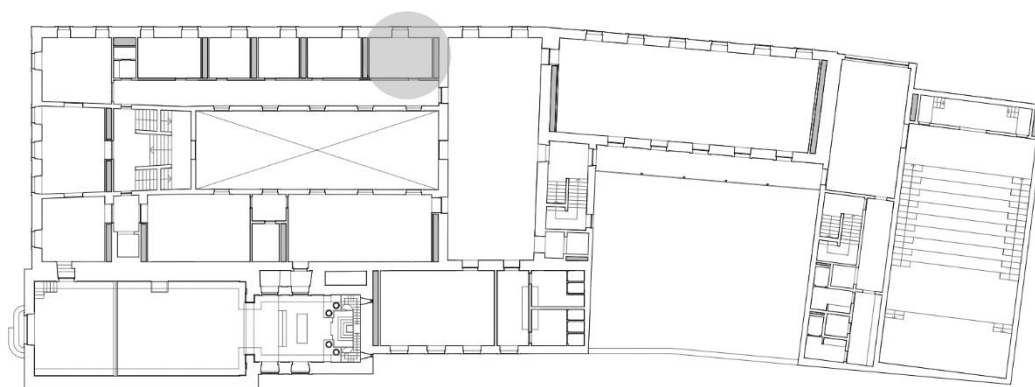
Planta. Seleção de estudo infraestrutural (Autor, 2023)
